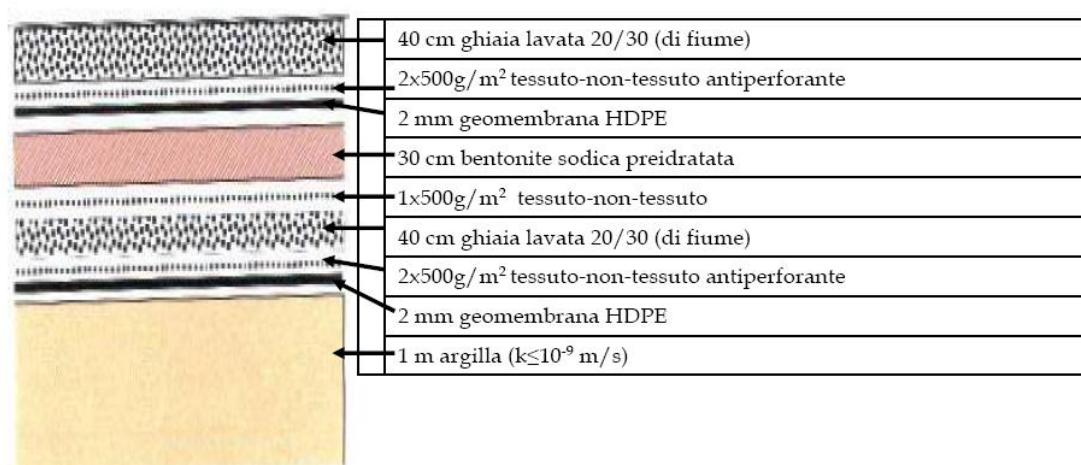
Esempio di impermeabilizzazione tipica fondo/pareti
